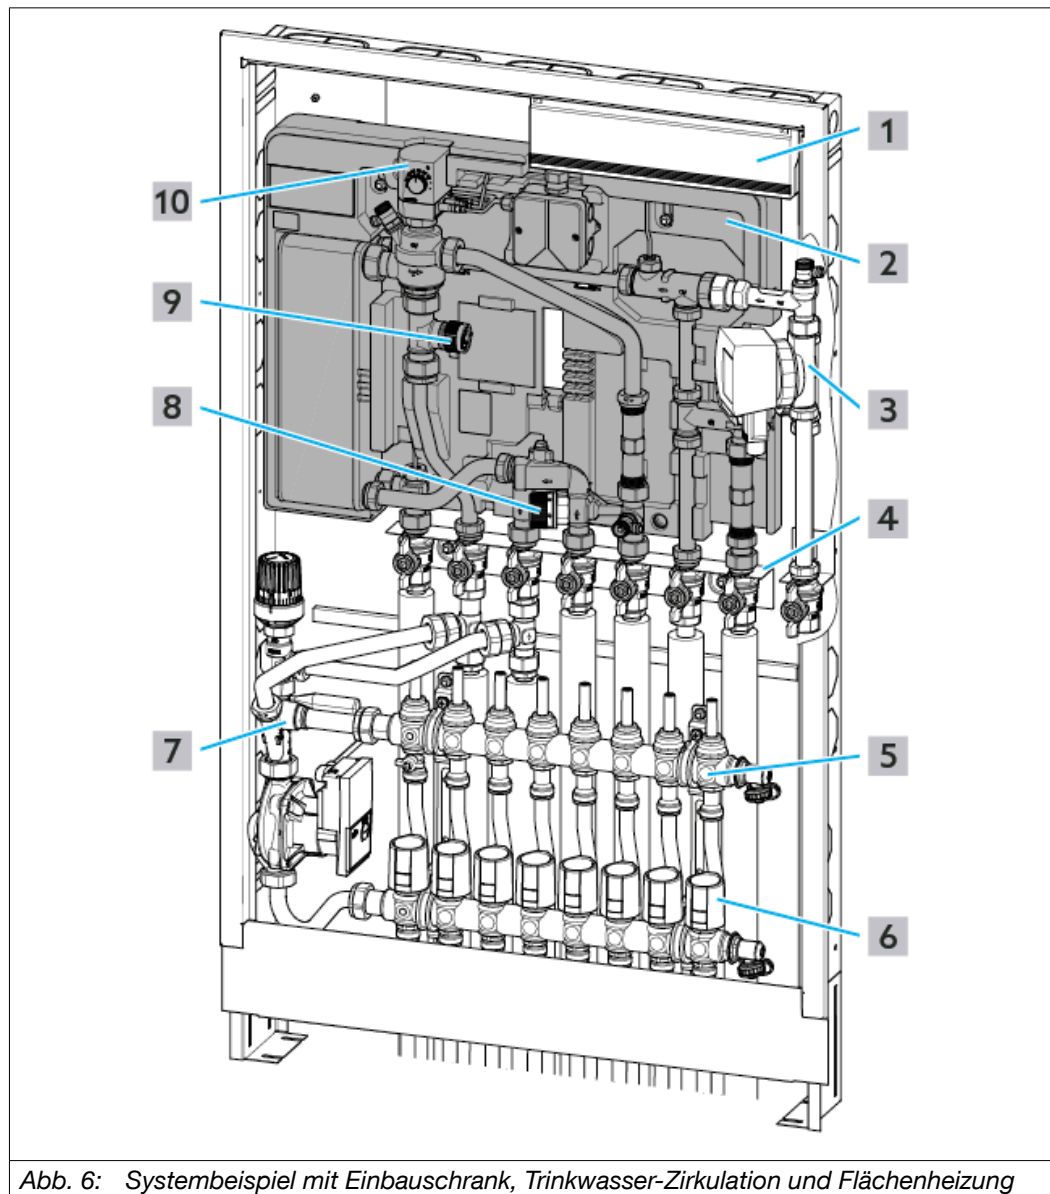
Systembeispiel mit Einbauschränk, Trinkwasser-Zirkulation und Flächenheizung
